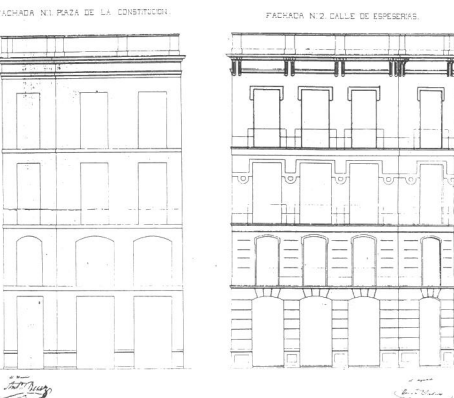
Proyecto de alzado exterior para Pza. Constitución nº 5. Fachadas a la Plaza y c/ Especiería, C. Salinas, 1870.
